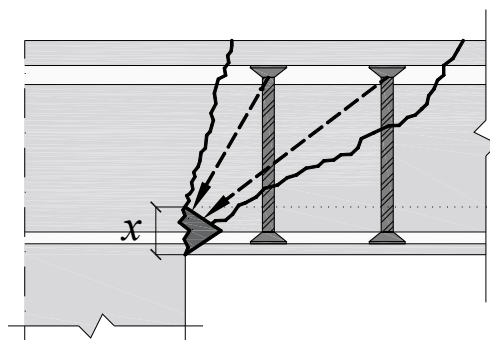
Modelo mecânico para lajes armadas proposto por BROMS (2005).
